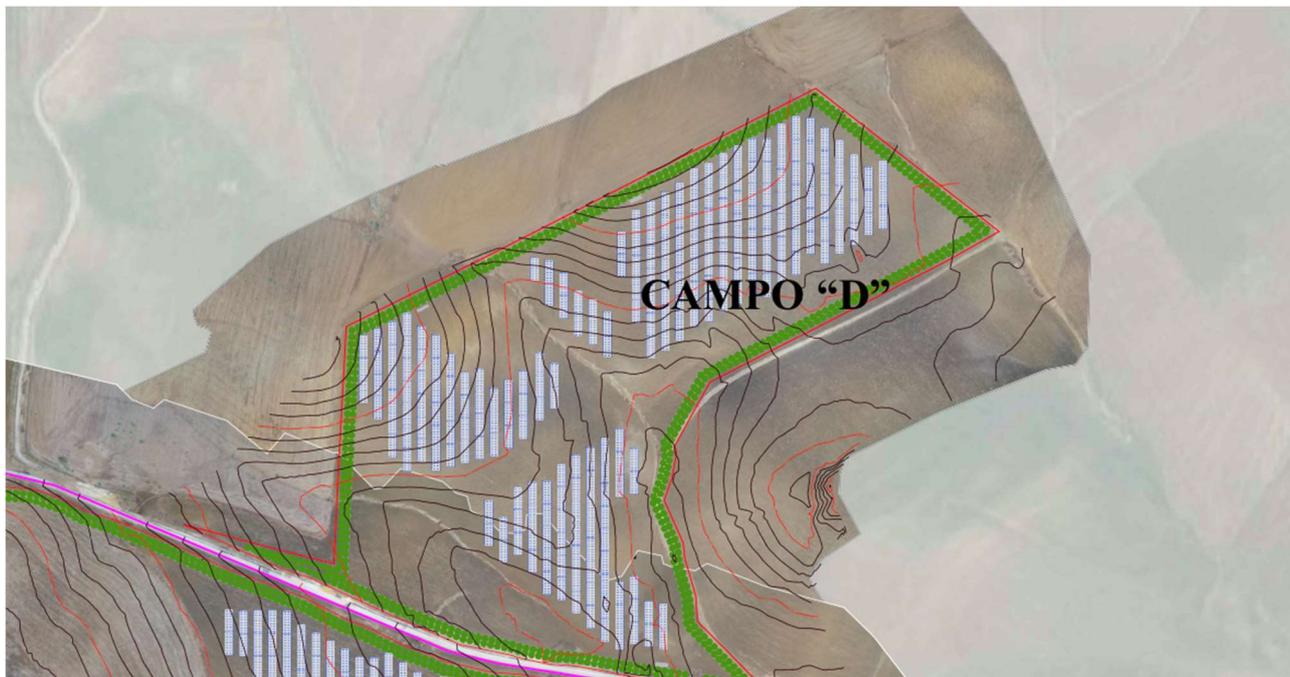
Particolare Layout di impianto area D su stralcio rilievo
